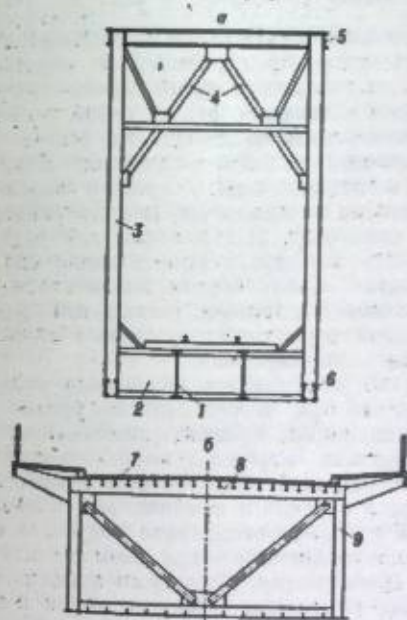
Основные элементы пролетного строения в поперечном разрезе: а — железнодорожное, с едой понизу; б — автомобильное, с едой поверху (1 и 2 — продольная и поперечная балки; 3 — решетчатые фермы; 4 — поперечные связи; 5 и 6 — верхний и нижний пояса фермы; 7 — асфальтобетон; 8 — ортотропная плита; 9 — стена сплошной фермы балки).
